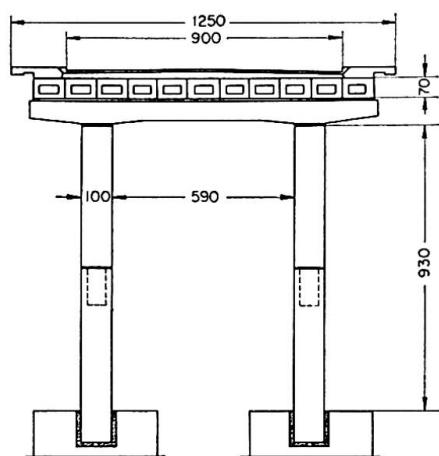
Anwendung des Zapfenstoßes für Stützrahmen von Fertigteilbrücken.
